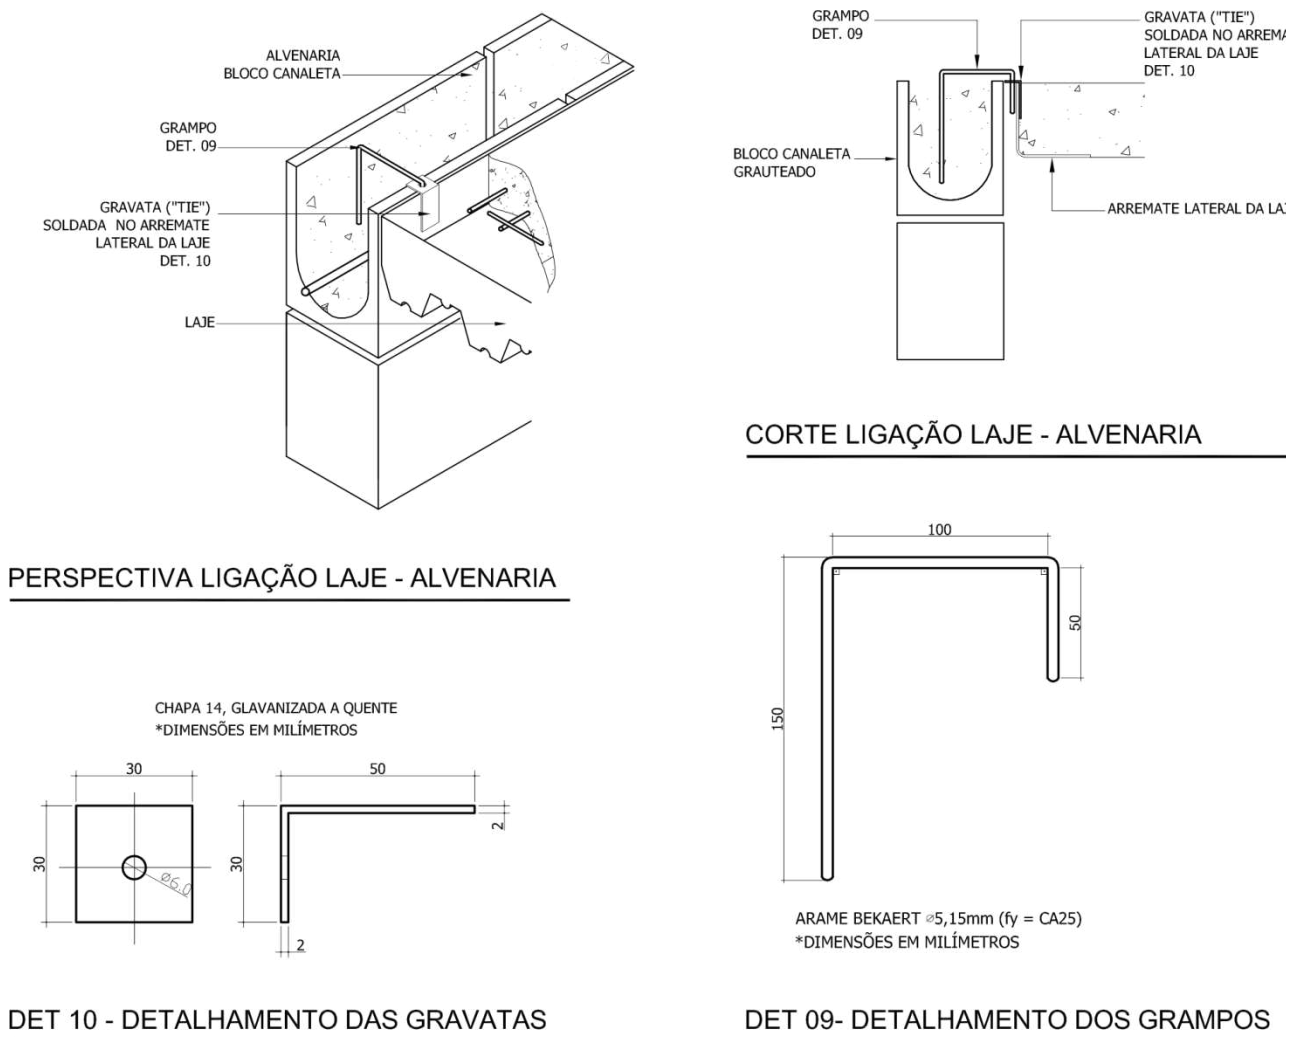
Detalhes do projeto de alvenaria para o dispositivo de conexão entre a alvenaria e a laje.
